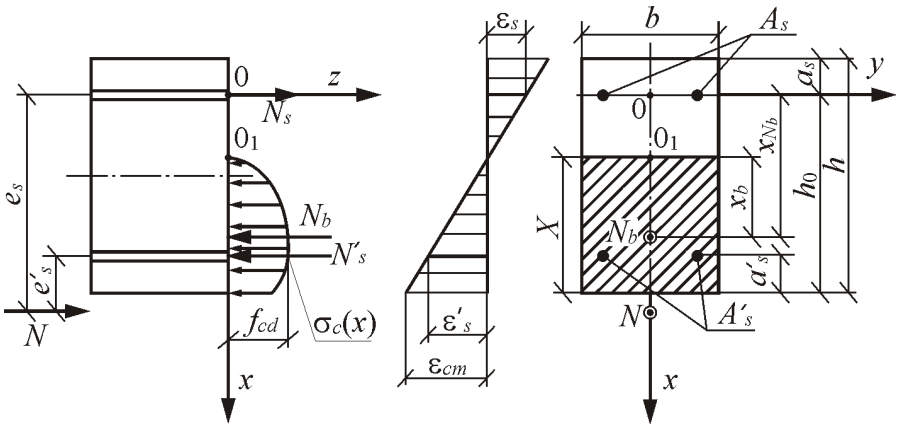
Розрахункова схема позациентрово стиснутого залізобетонного елемента
